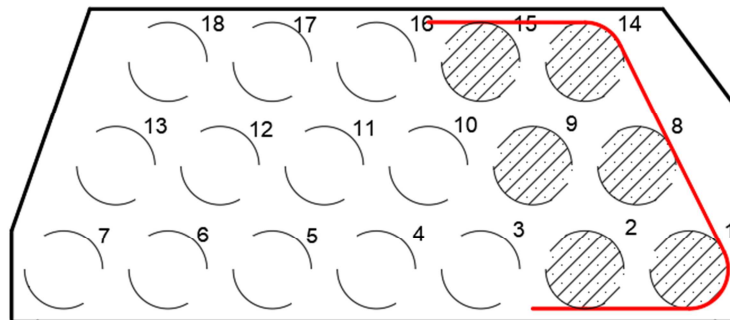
Gruppo di 6 pali di fondazione maggiormente caricati
